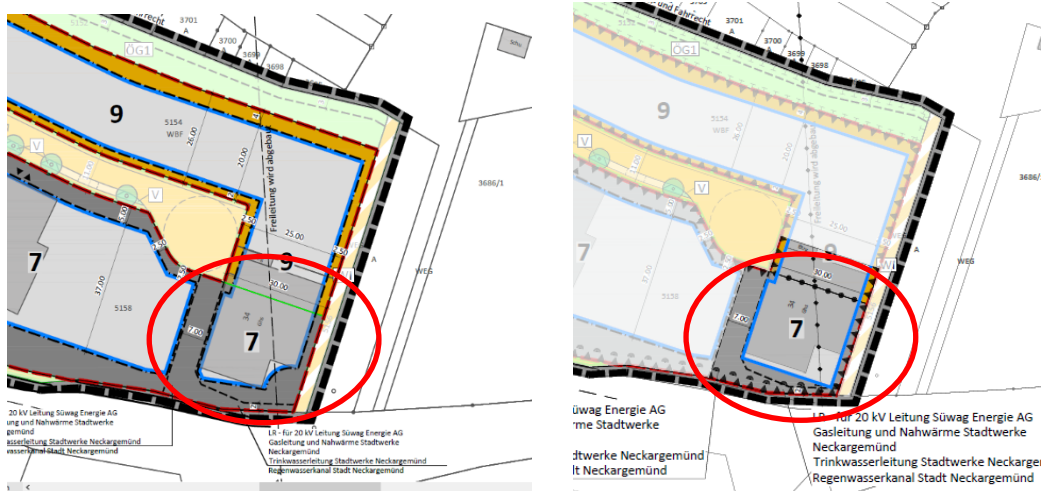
Gegenüberstellung Bebauungsplan Kleingemünd und „Teiländerung Kleingemünd“
